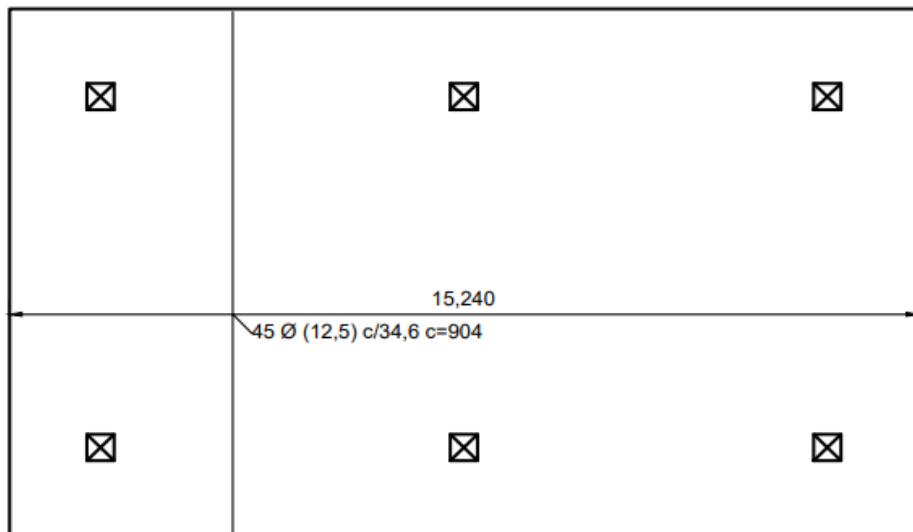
Armadura transversal inferior. Adaptado de Fick (2008)
